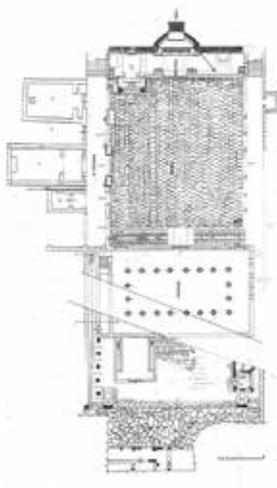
Pianta del foro di Baelo Claudia a Belo.
